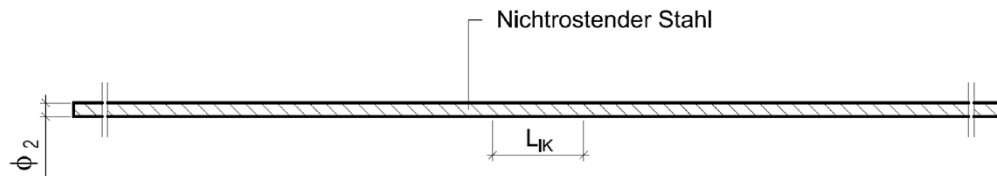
Zugstab aus nichtrostendem Betonstahl
